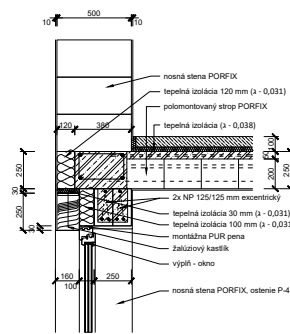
MURIVO 375 - POLOMONTOVANÝ STROP,
